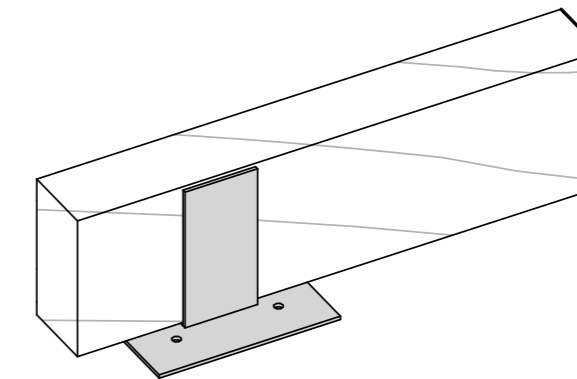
Sistema constructivo de vigas macizas de madera, propio.
